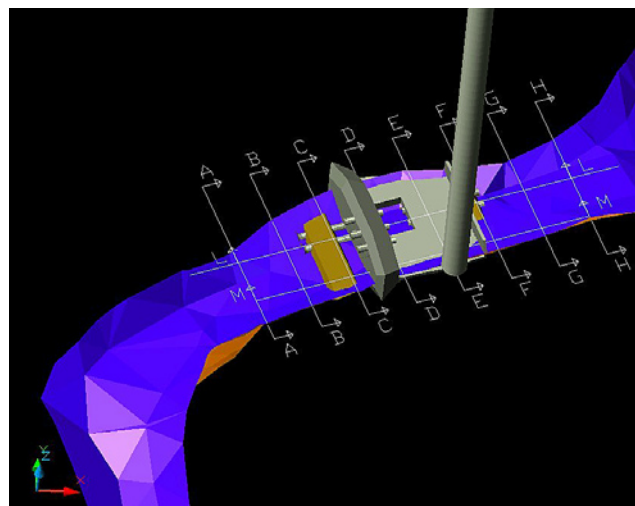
Geplantes Sperrbauwerk mit Kleinwasserkraftanlage und Zugangsschacht
